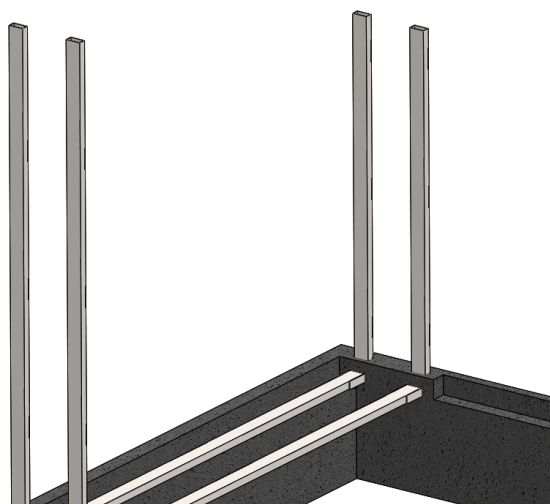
Encaixe dos pilares, vigas e respetivos encaixes.
